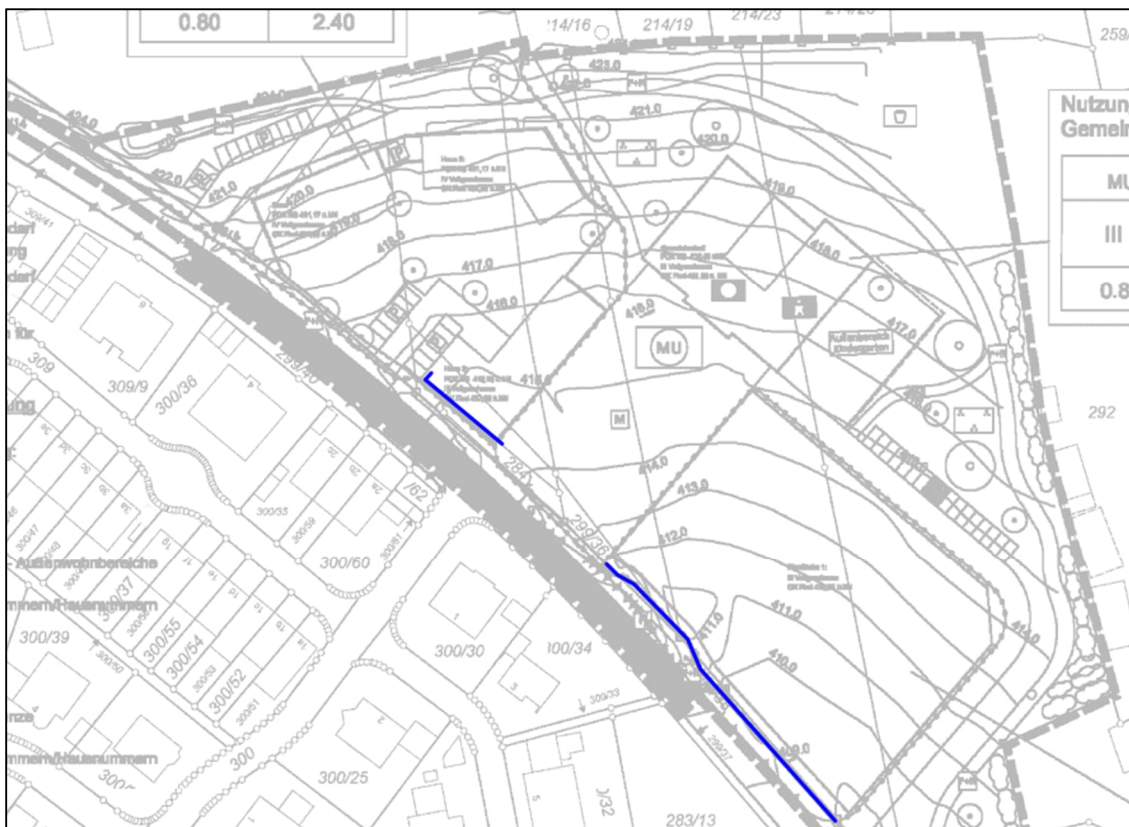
Lageplan mit Darstellung der Fassaden an denen Außenwohnbereiche geschützt werden müssen
